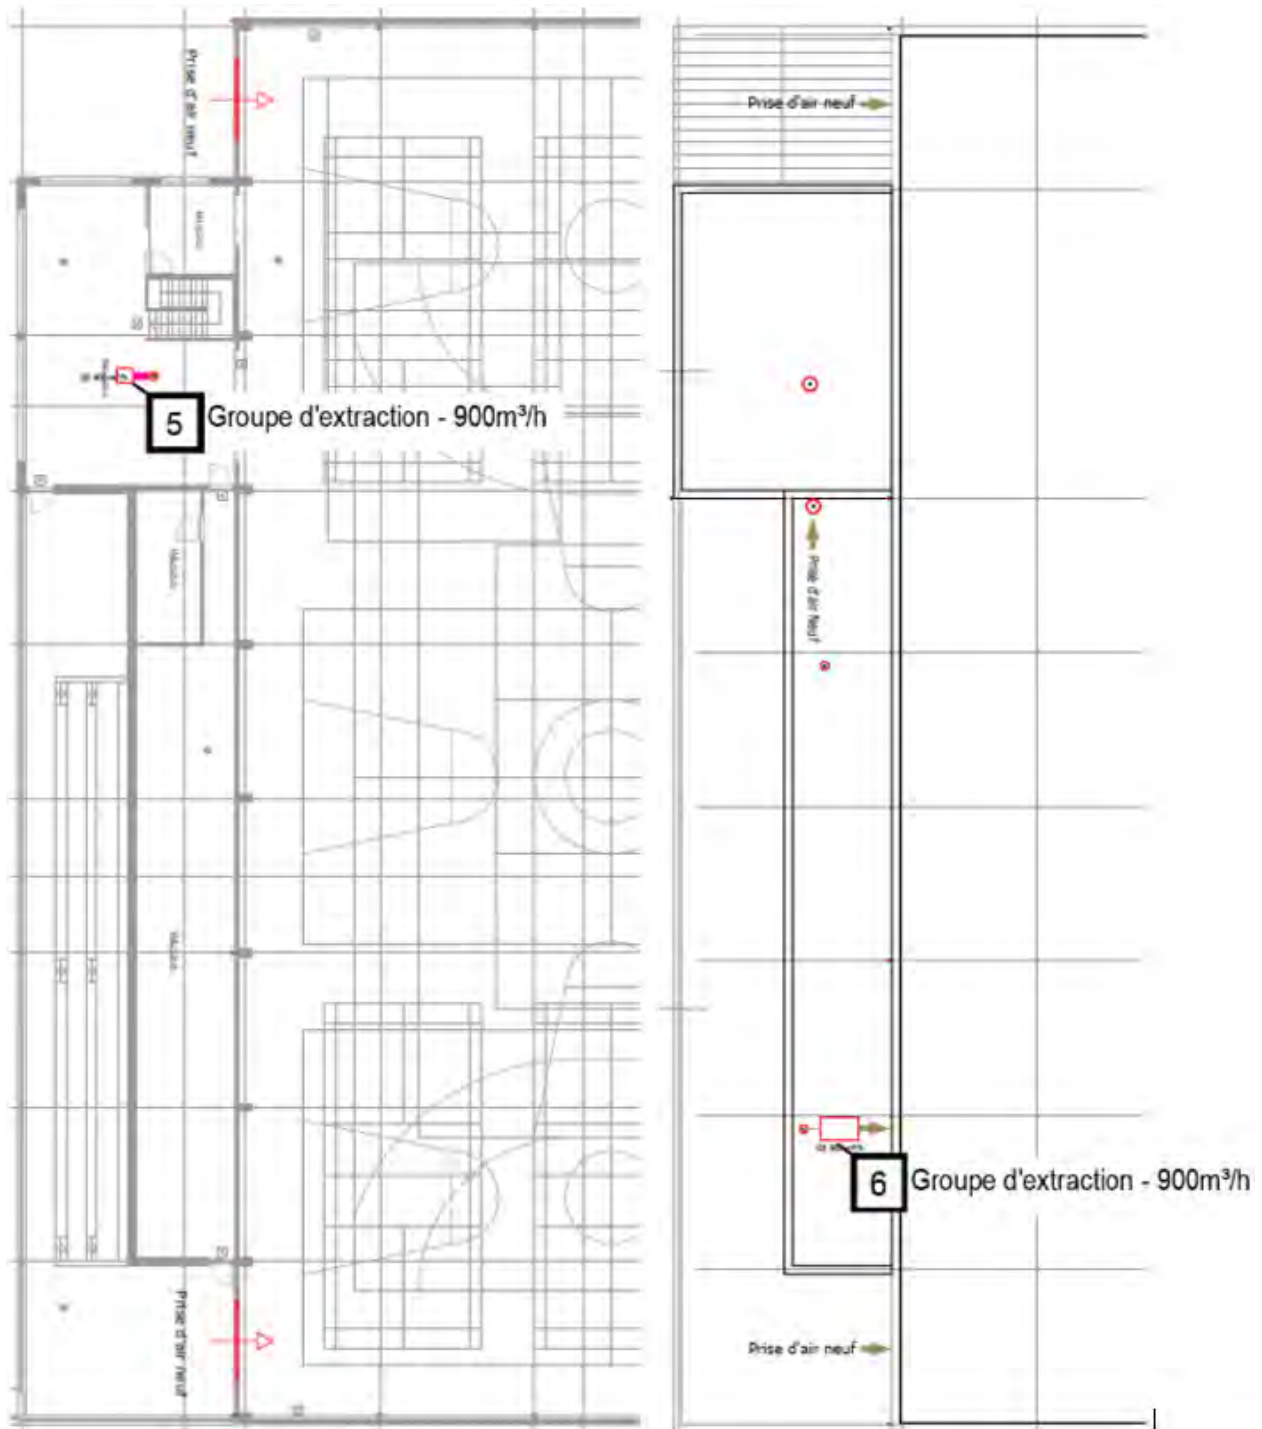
Localisation des groupes de ventilation (extraction) du Hall0 au 1<sup>er</sup> étage (5) et en toiture (6) (MK Engineering, 2018)
